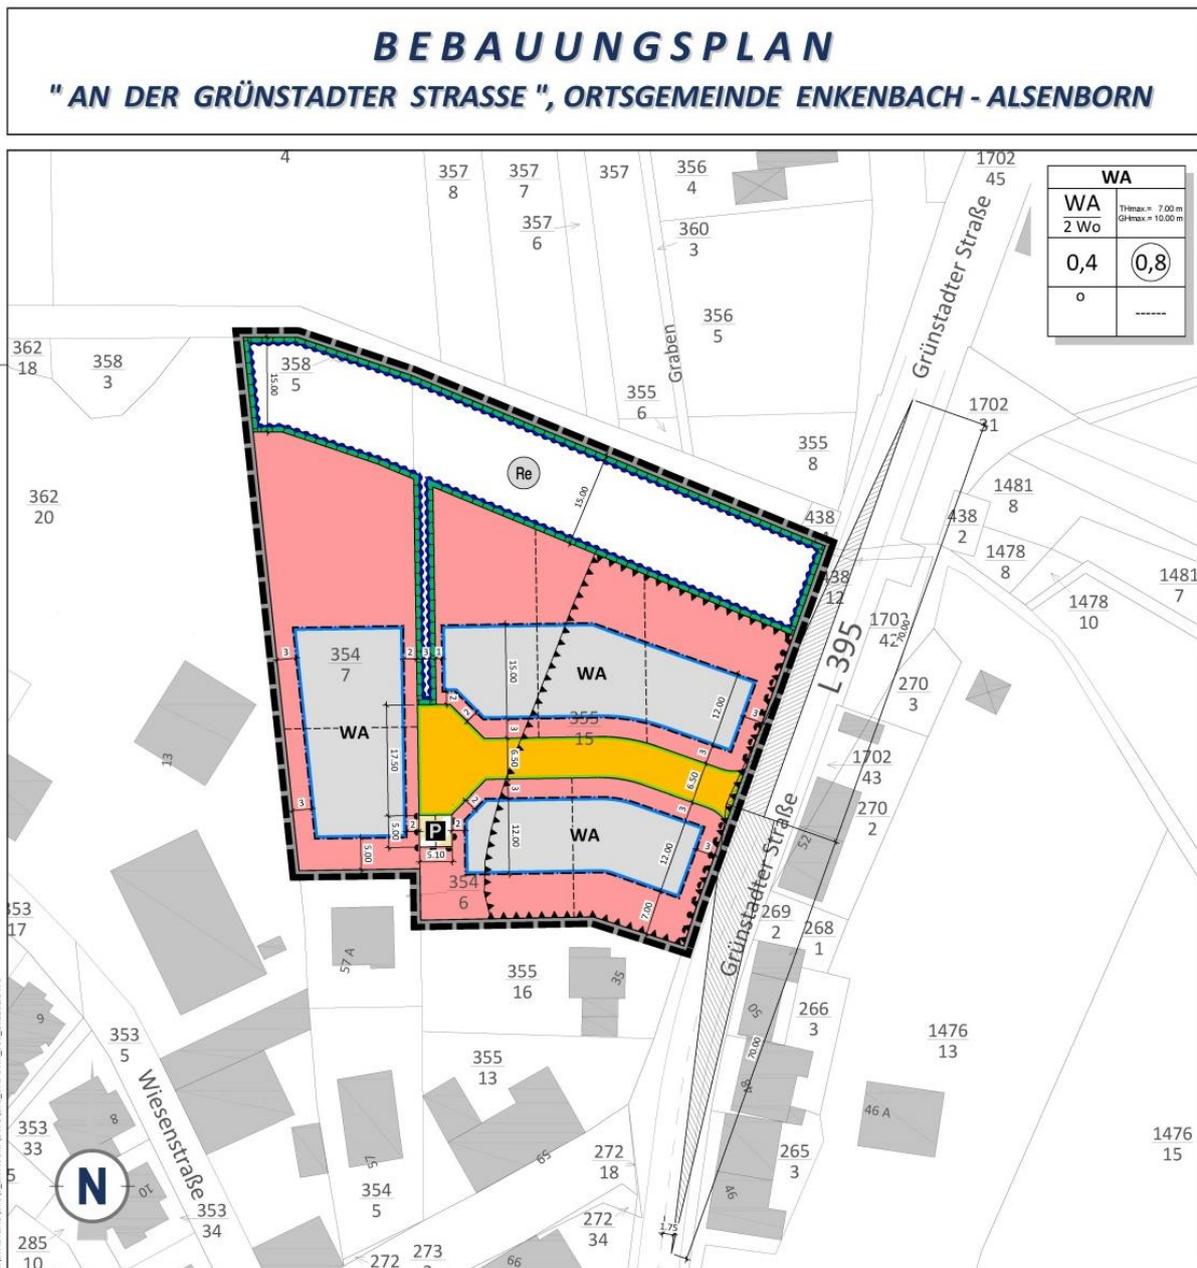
Planzeichnung, Bebauungsplan – Entwurf, Stand: November 2016
